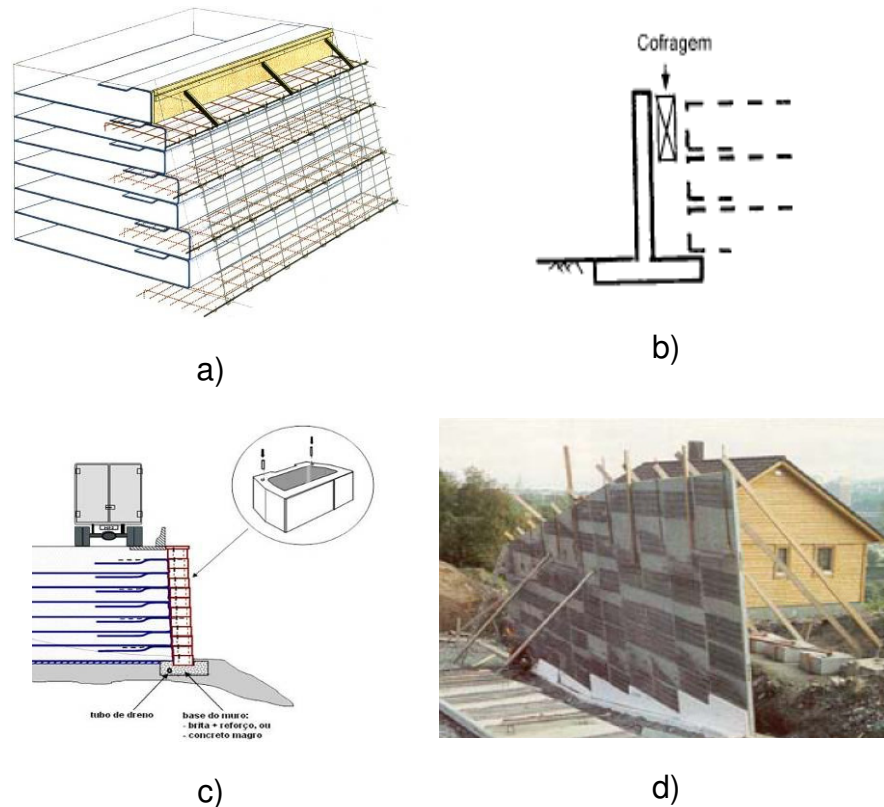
Quatro métodos de construção distintos para estruturas reforçadas: a) com cofragem, MPZ (2008); b) cofragem entre muro e solo, Gourc (1996) c) com elementos de betão, MPZ (2008); d) sistema de escoramento, IGS- Mini Lectures.Gourc.
